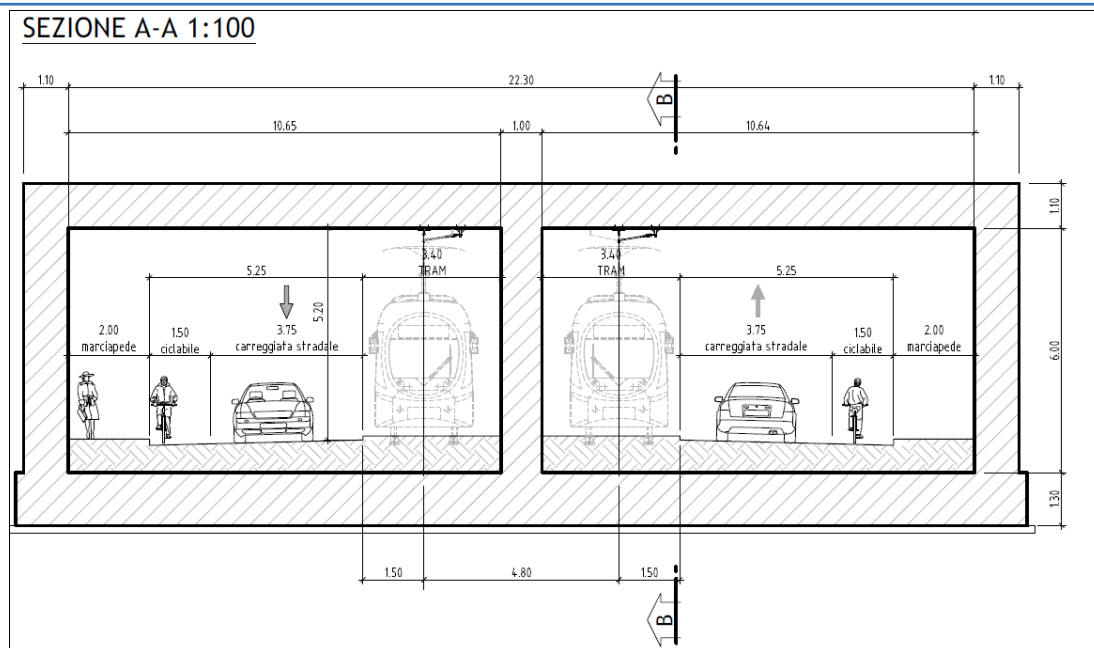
Sezione trasversale sottoattraversamento (estratto da elaborato B831-C-SF-STR-RT003)
